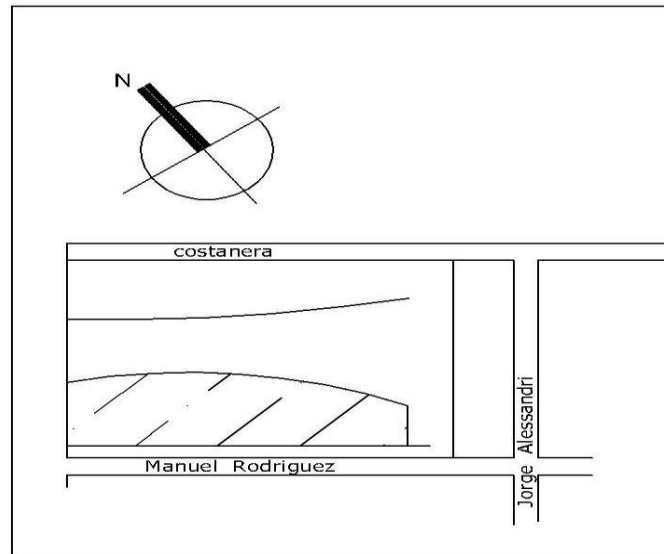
6. Plano de Ubicación. Fuente: propia
